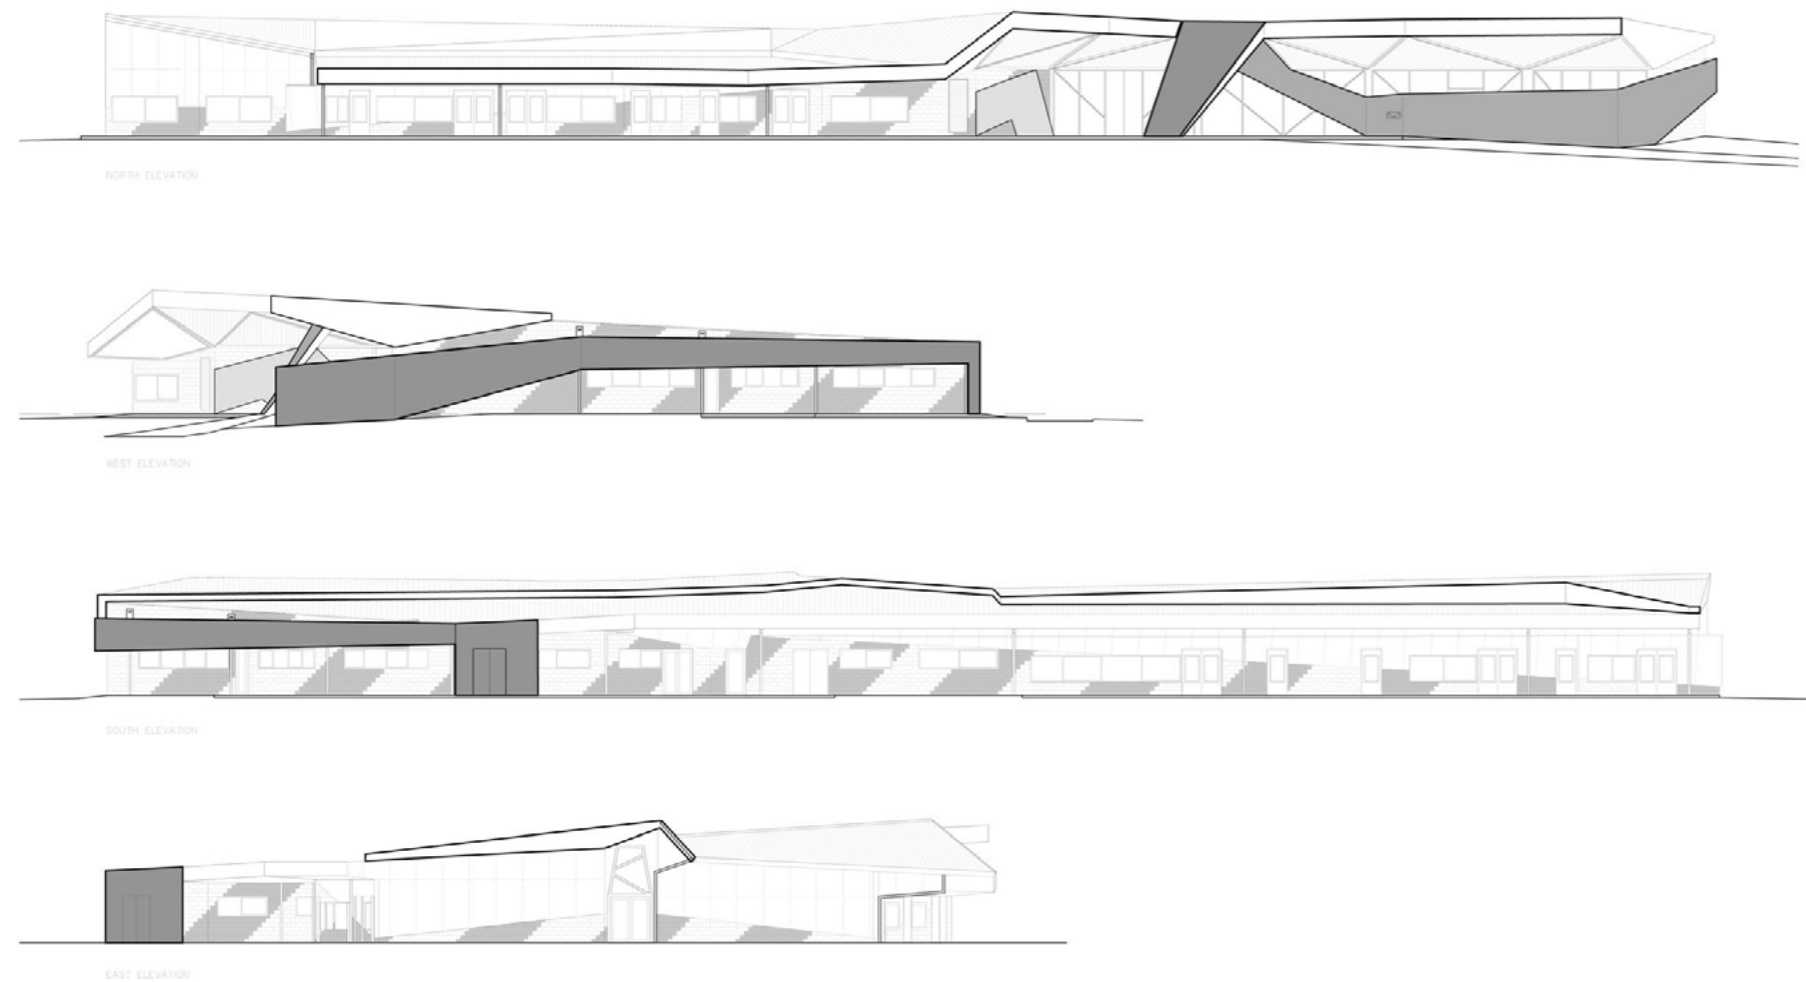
Planimetría del Centro Intergeneracional Churchill
